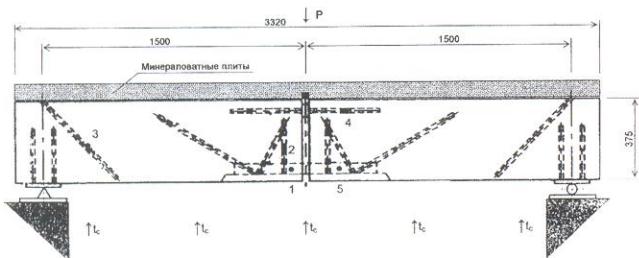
Эскиз опытного образца деревометаллической балки с узловым соединением фермы и схема расстановки термопар:
